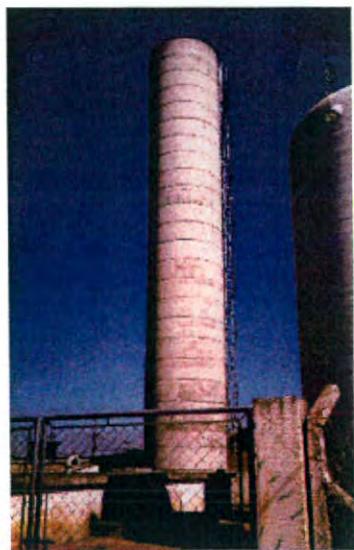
Centro de reservação Jardim das Paineiras – RP1 – 70 m<sup>3</sup>
